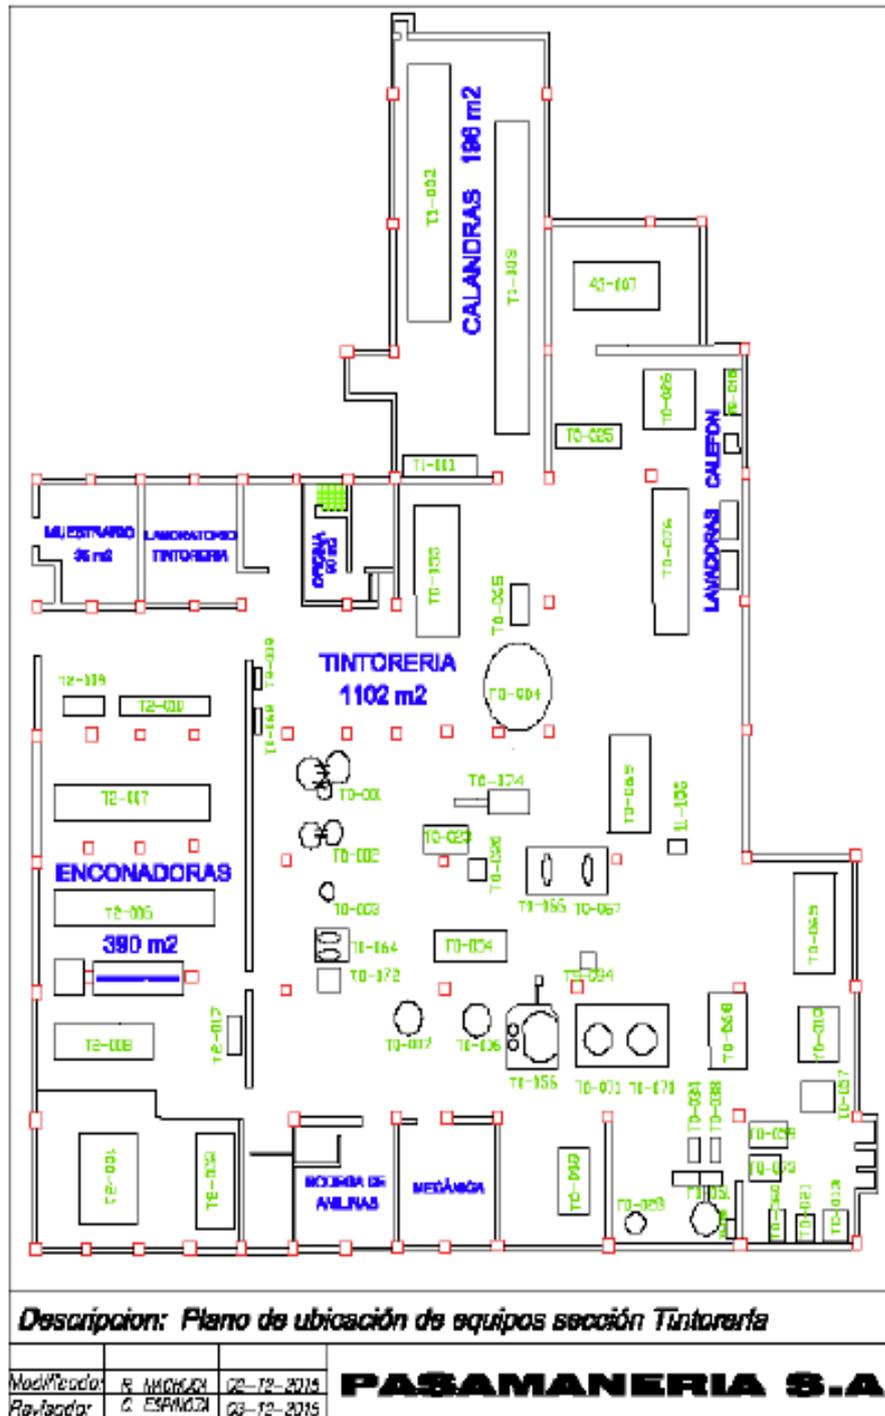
Plano de ubicación de equipos en la sección Tintorería.
